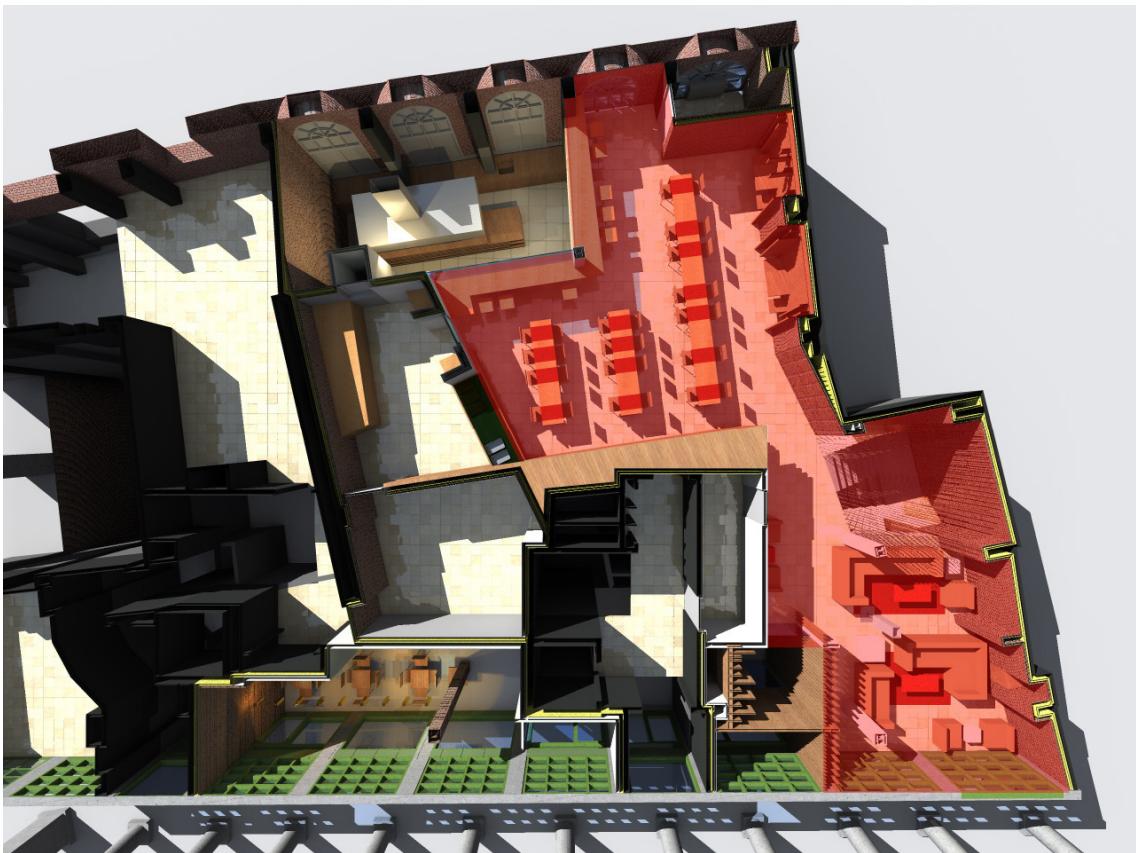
9_ Tiempo de reverberación: Zona de restaurante en entreplanta
